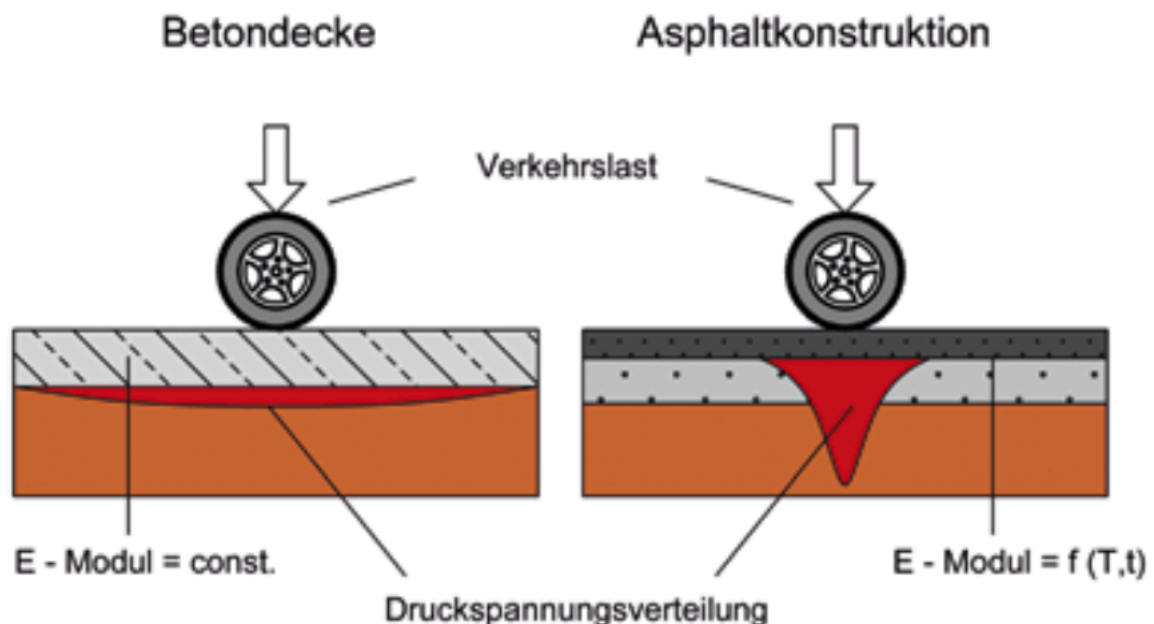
Lastübertragung in dem Untergrund von Betondecke und Asphaltkonstruktion [4]
